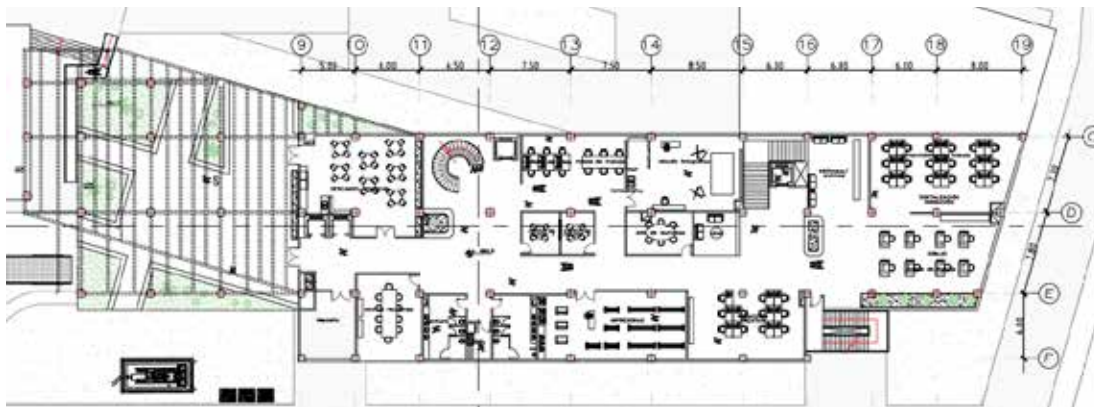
Planta Nivel 1 Fuente: La Autora (2020)
